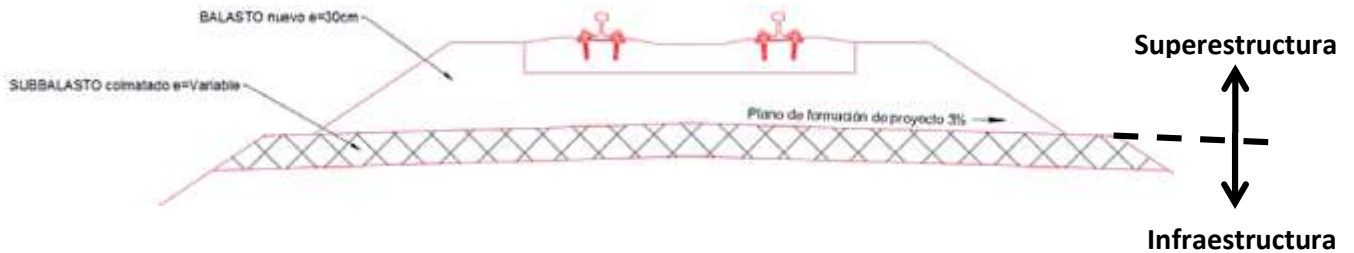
Esquema de infraestructura y superestructura. Fuente: Elaboración propia.
